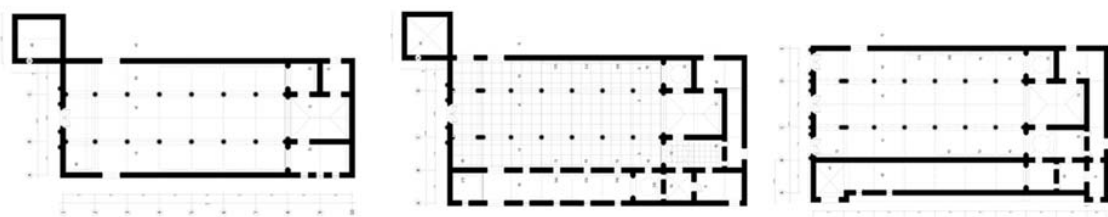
Reconstrucción de las plantas del templo en 1600-1641, 1772 y 1812.
